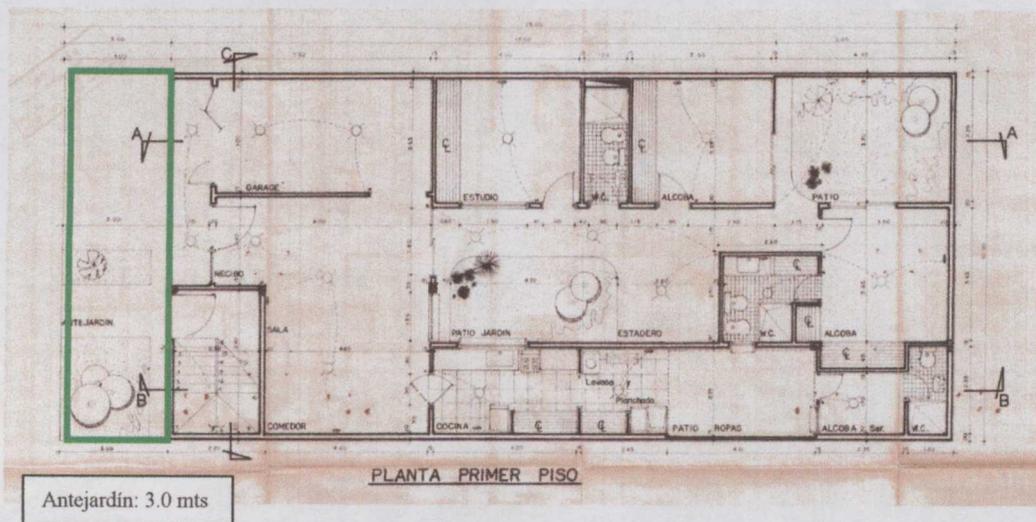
planos aprobados por la Secretaria de O.O.P.P.M.M sección control y Oficina del Plano Regulador Licencia de Construcción No. 334. Registro No. 134 de 13 de septiembre de 1973
